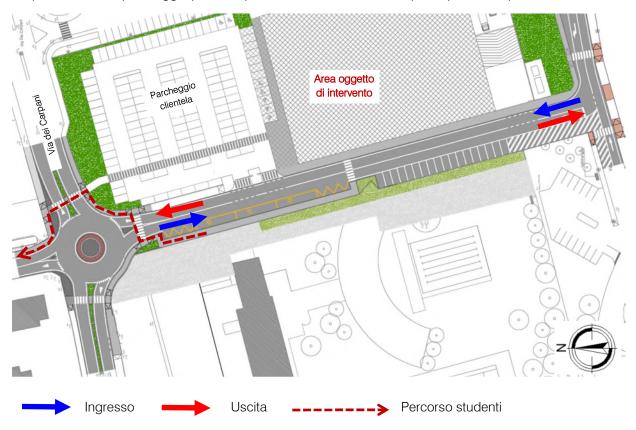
Identificazione intervento commerciale di progetto con individuazione accesso alla struttura
